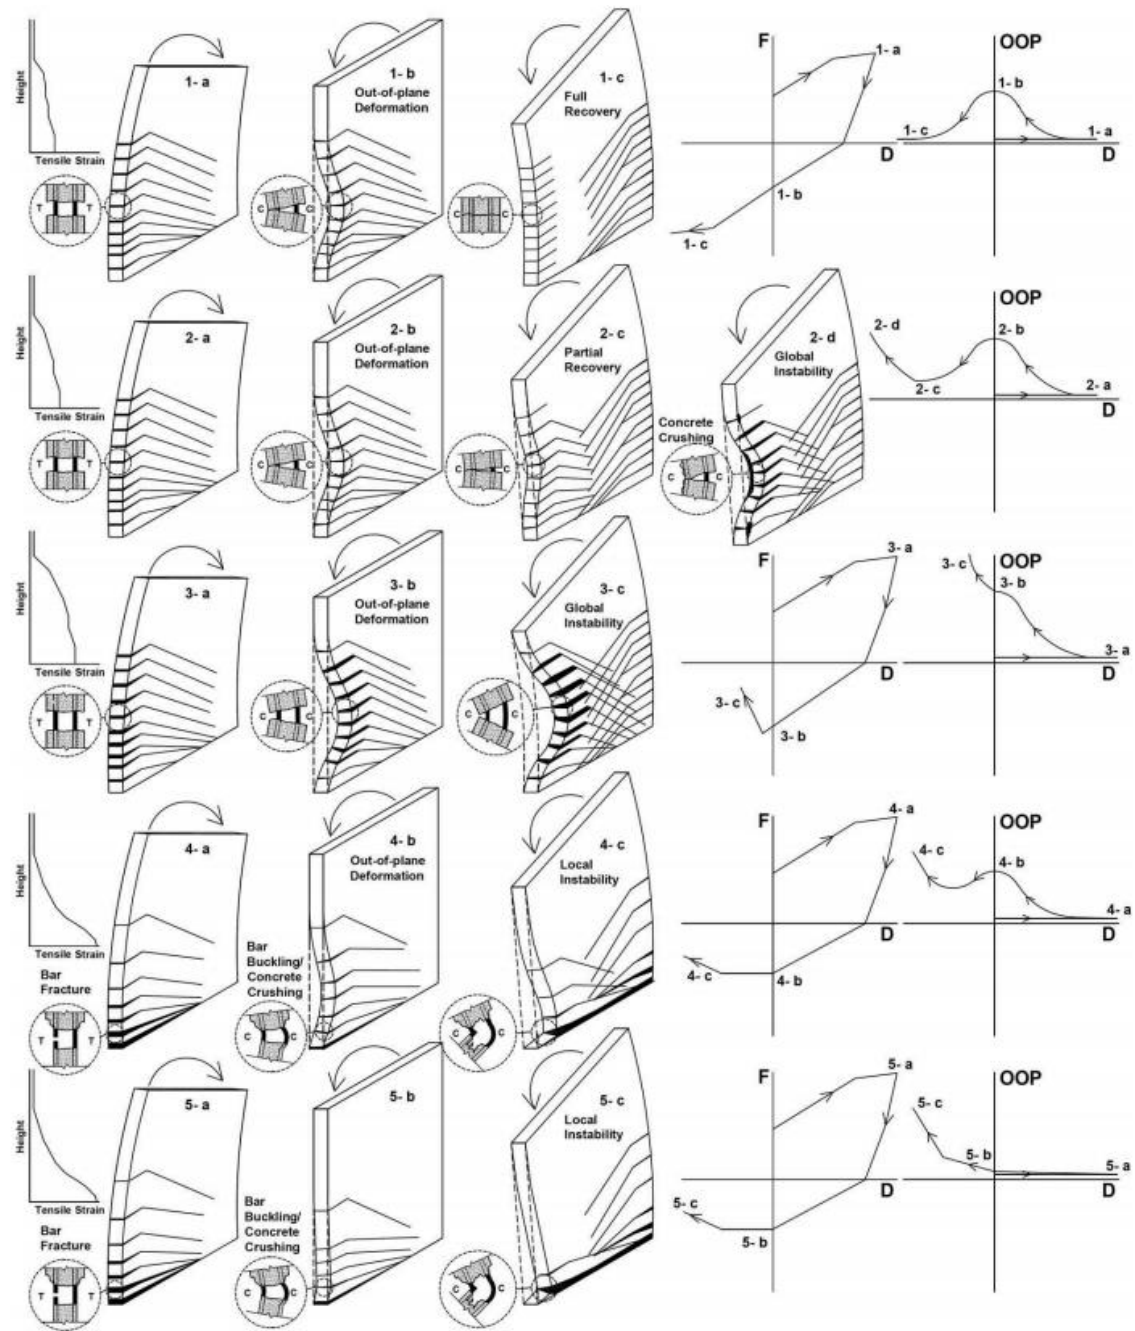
Clasificación de la respuesta fuera de plano en muros bajo cargas en plano, Dashti et al [10].
